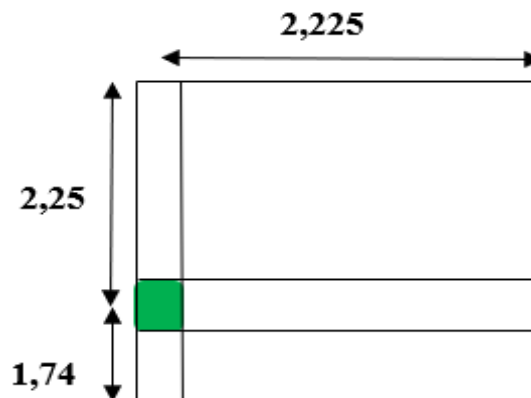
schéma de la surface la plus chargée de poteau d'angle.
